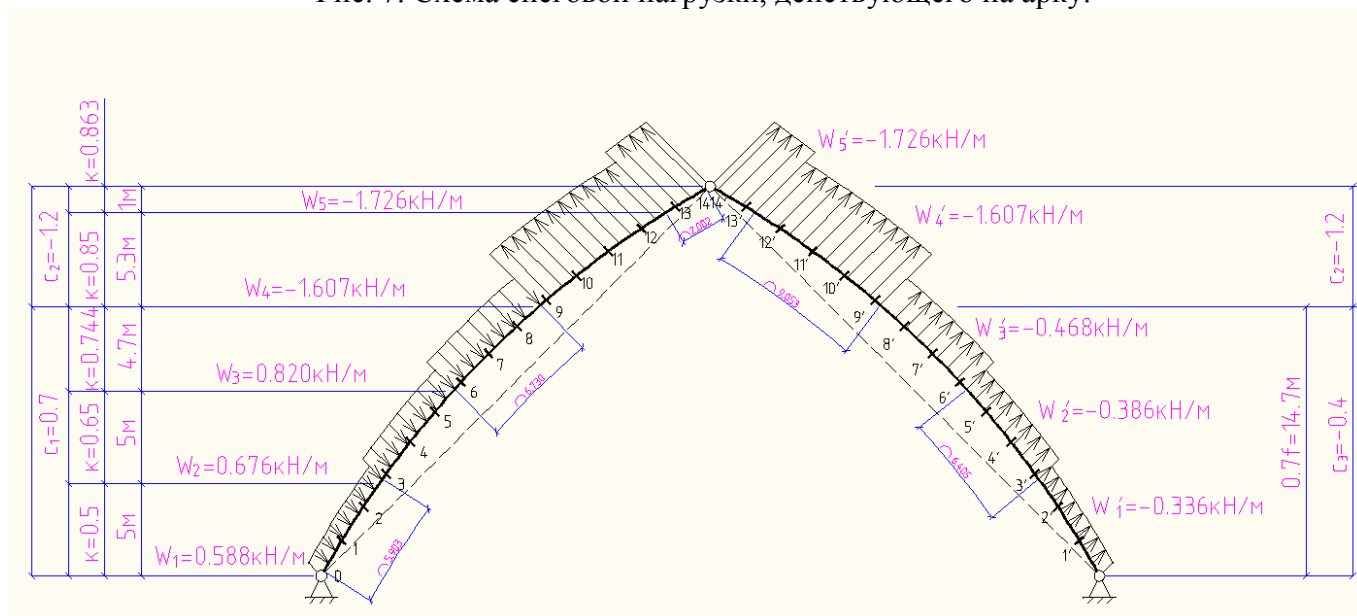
Схема ветровой нагрузки, действующей на арку.
